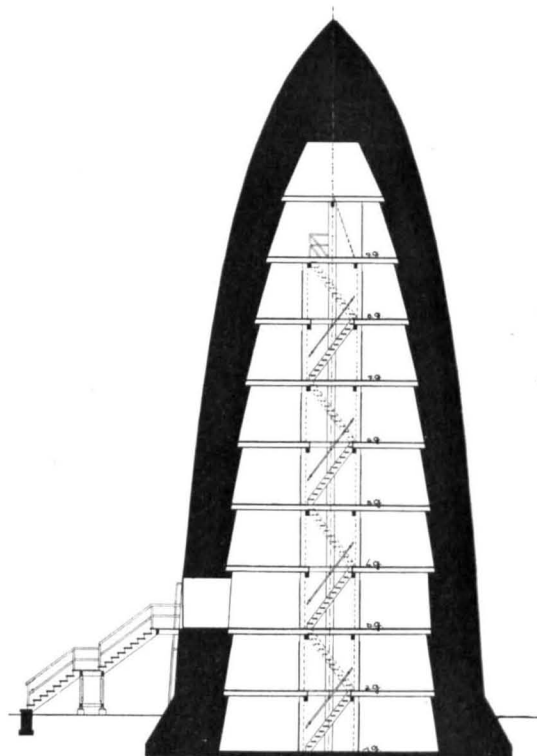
Luftschutzturm „Bauart Winkel“ aus Stampfbeton ohne Eiseneinlagen. Fassungsvermögen 500 Personen.
